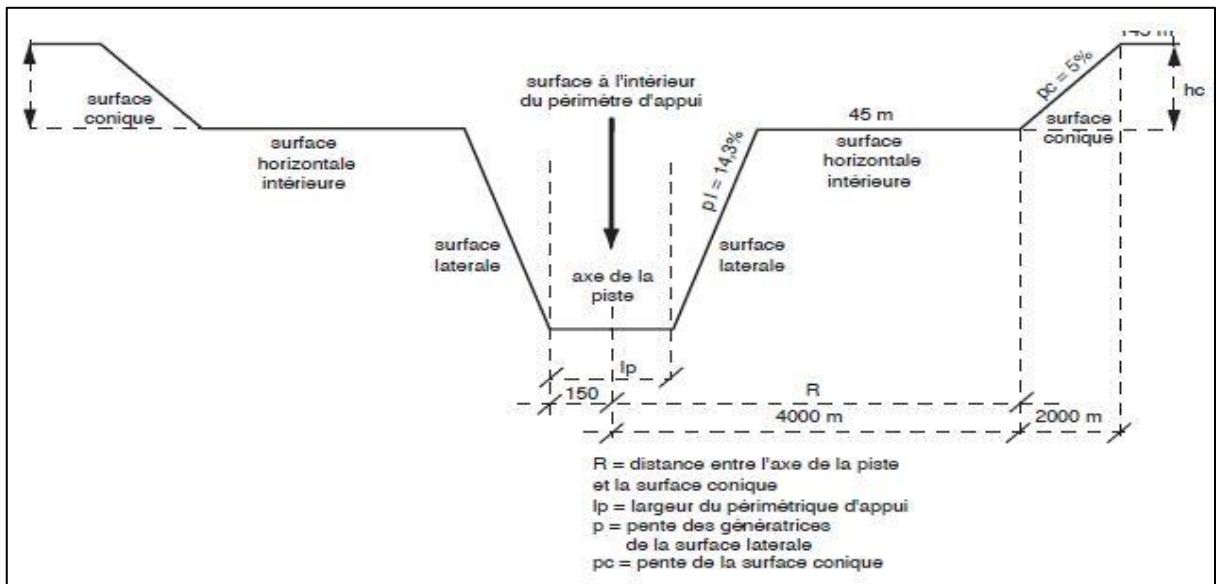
Coupe transversale du plan de servitudes aéronautiques de dégagement.[4]
